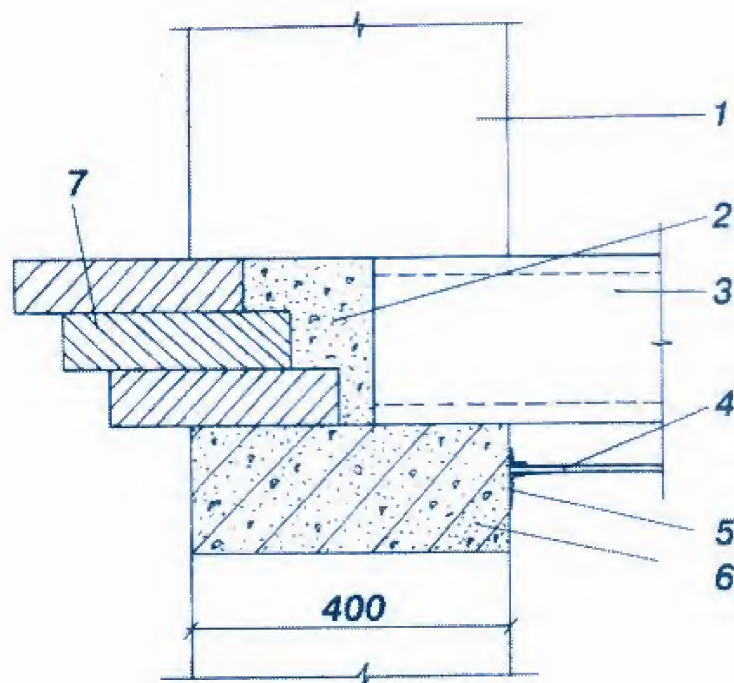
Перекриття першого поверху: 1 — пінобетон; 2 — бетон М200; 3 — залізобетонна пустотіла плита; 4 — обшивка стелі гіпсокартоном; 5 — паморозь, що утворилася; 6 — залізобетонний монолітний пояс; 7 — цегляний карниз
